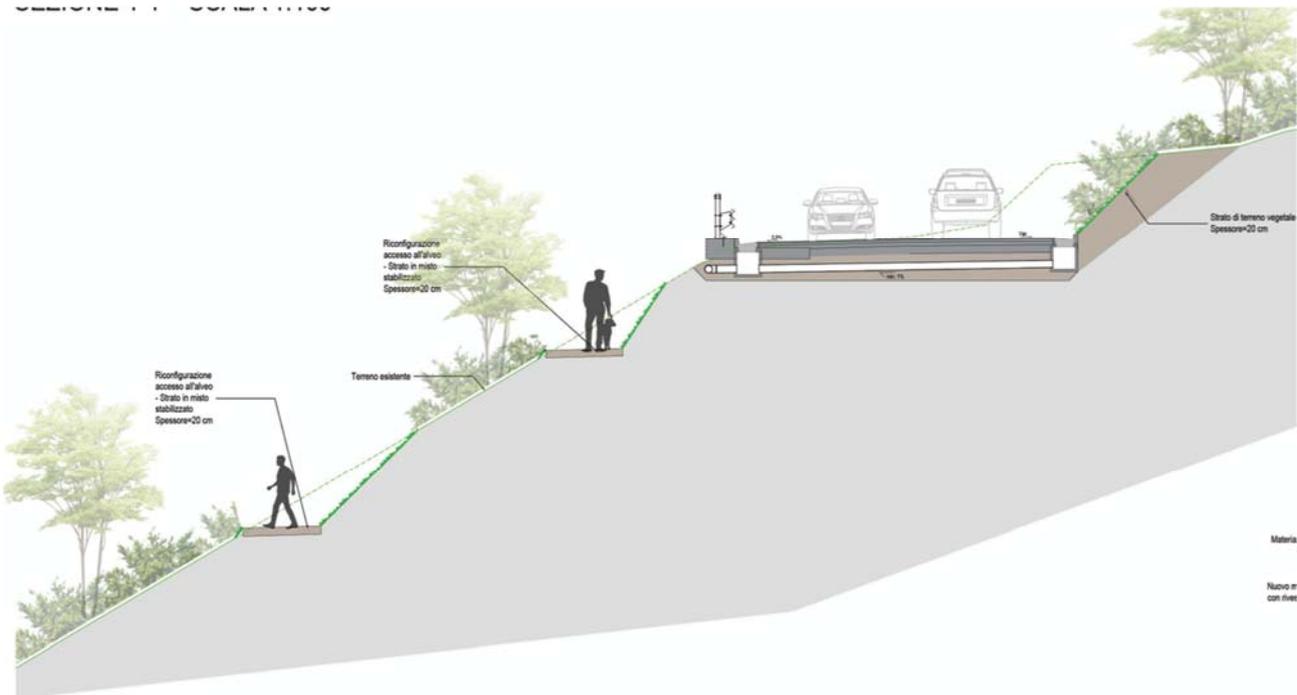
sezione tipo del rinverdimento lungo la spalla lato Genova
